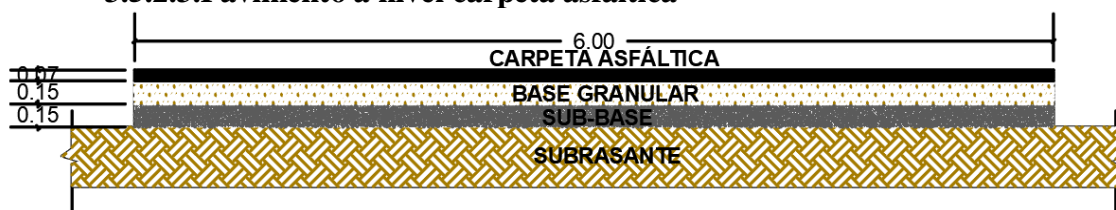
Corte transversal de pavimento a nivel de carpeta asfáltica
